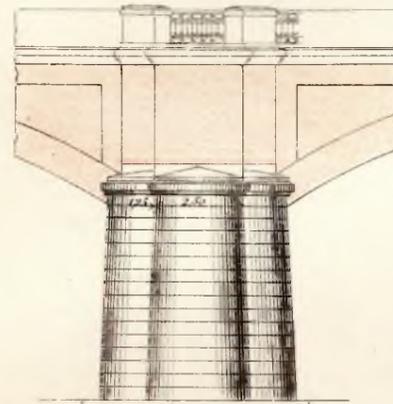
, 11. — Elevazione a valle di una pila e di una pila-spalla.
